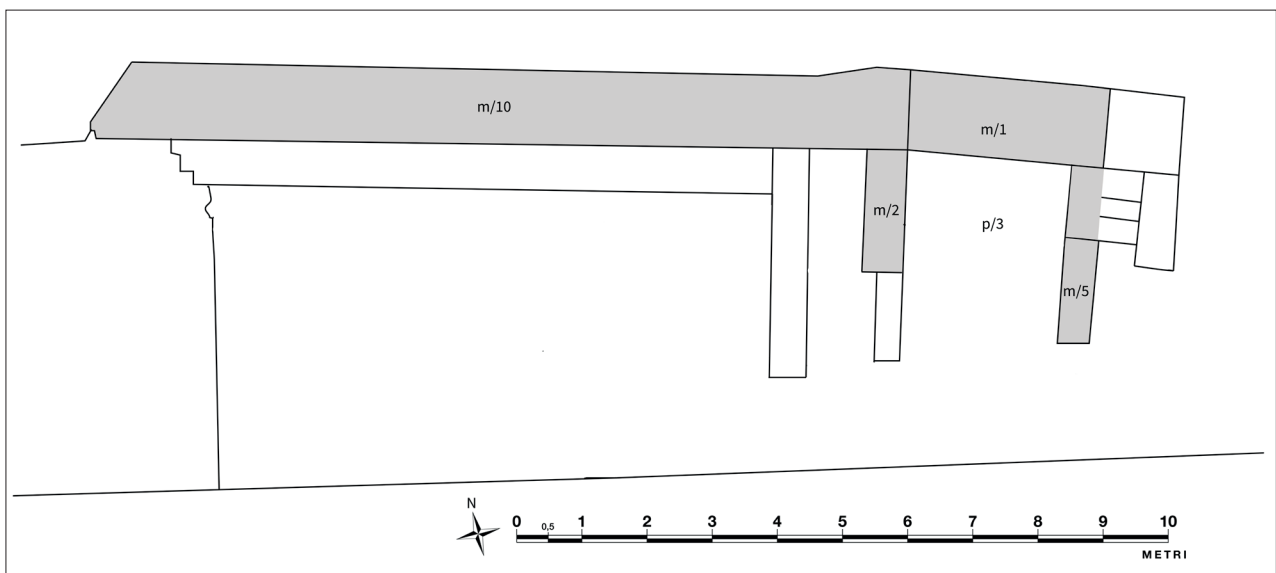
Pianta schematica delle strutture attribuite alla Fase costruttiva 2 dell'edificio
